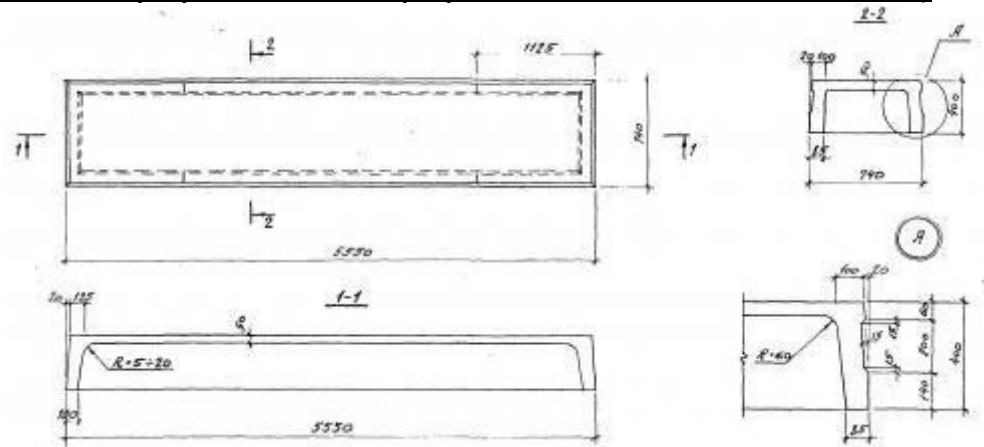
Ребристая плита перекрытия габаритами 0.74x5.55x0.4
